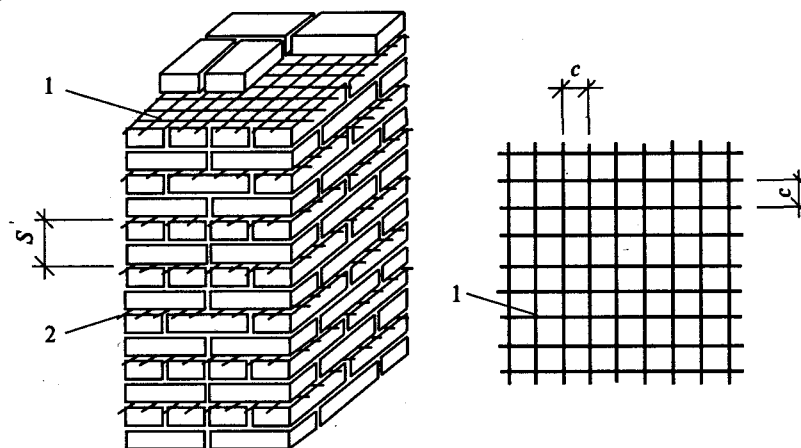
Поперечное (сетчатое) армирование каменных конструкций: 1 — арматурная сетка; 2 — выпуски арматурной сетки для контроля ее укладки;  $c$  — размер ячейки арматурной сетки;  $S$  — шаг арматурных сеток
